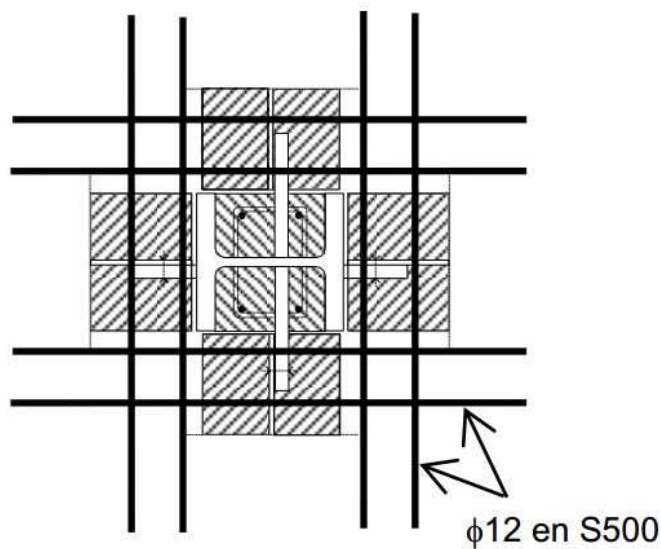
Disposition des armatures additionnelles pour les poteaux centraux
